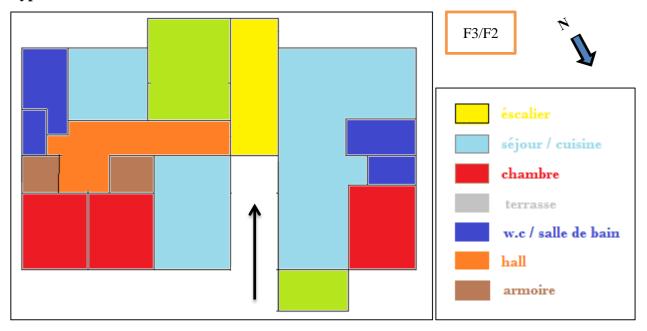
type 3 plan RDC F3 / F2 $\,$
